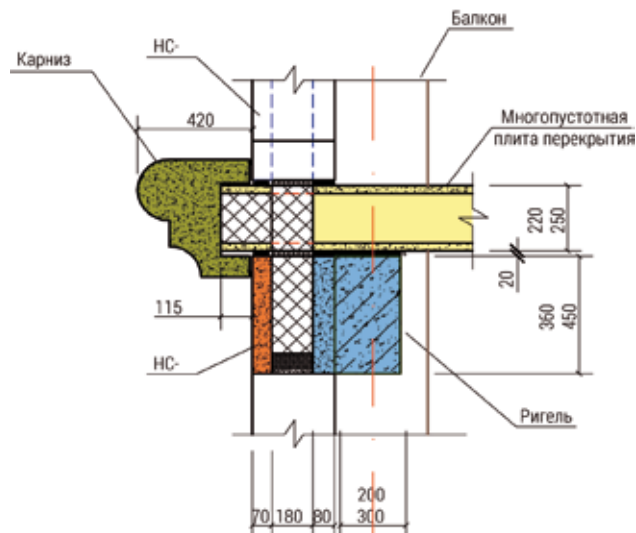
Устройство карнизов на панельных и панельно-каркасных зданиях
